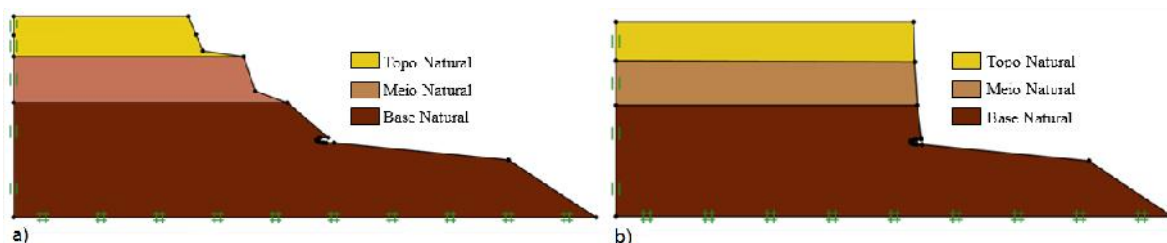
a) Perfil de 45°; b) Perfil de 90°.
